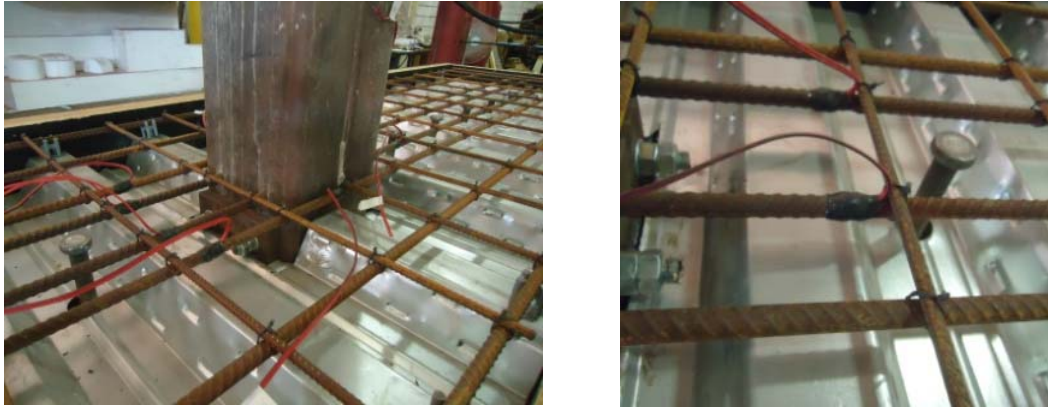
Instrumentação das barras de aço da laje do Modelo 1 e Modelo 3.
